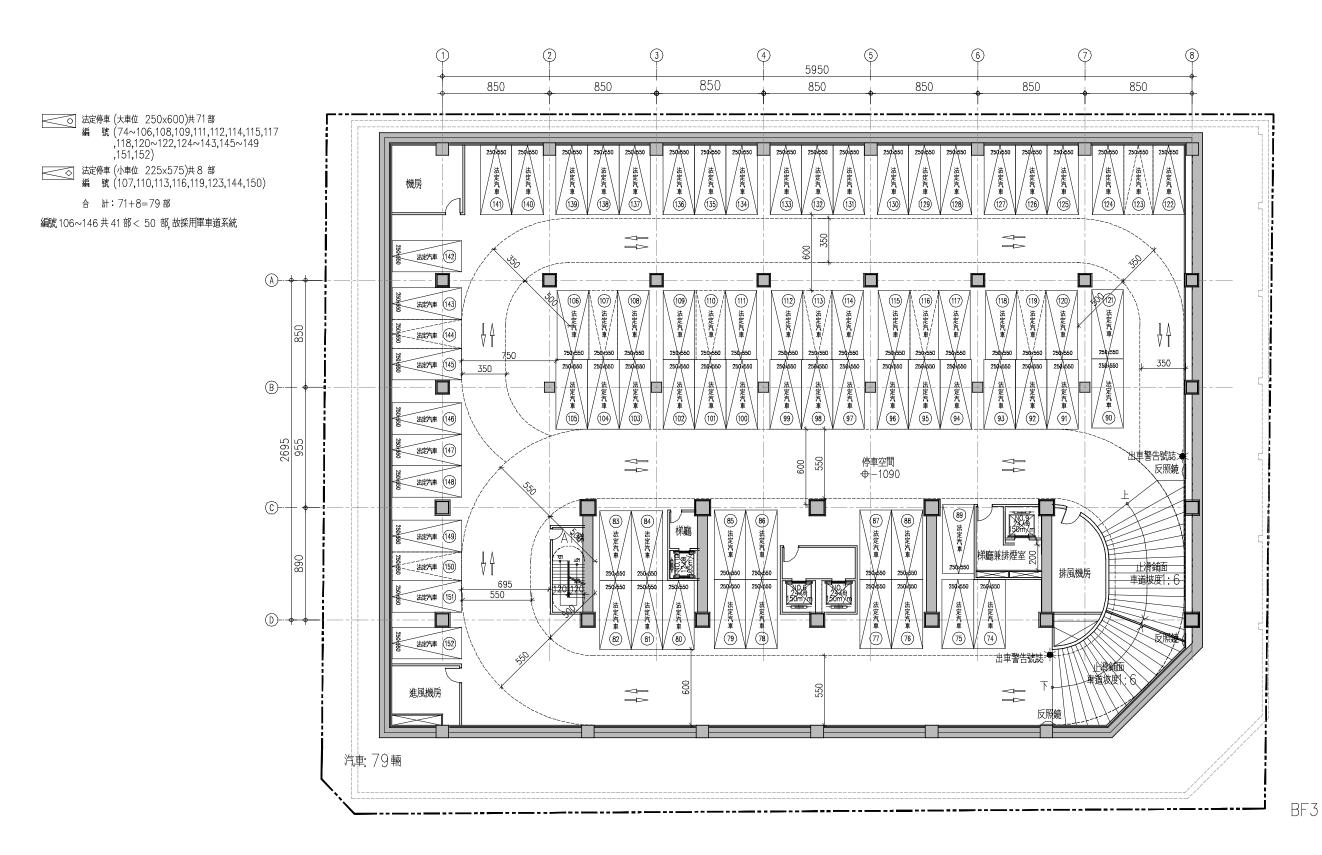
地下三層平面配置圖(S:1/300) 🔷
